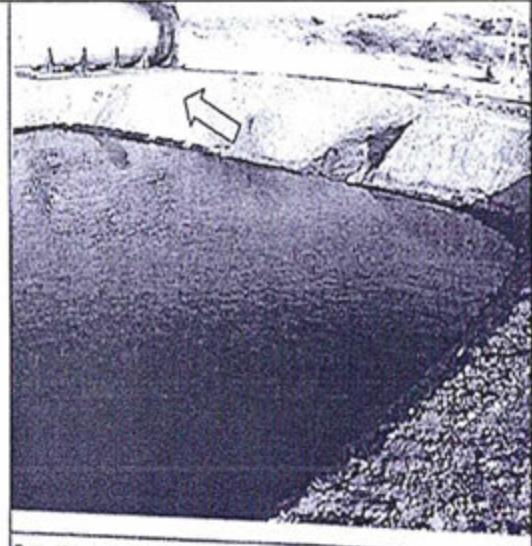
Vista adicional de la fosa con suelos contaminados, obsérvese el tanque usado en la prueba de producción manchado.
